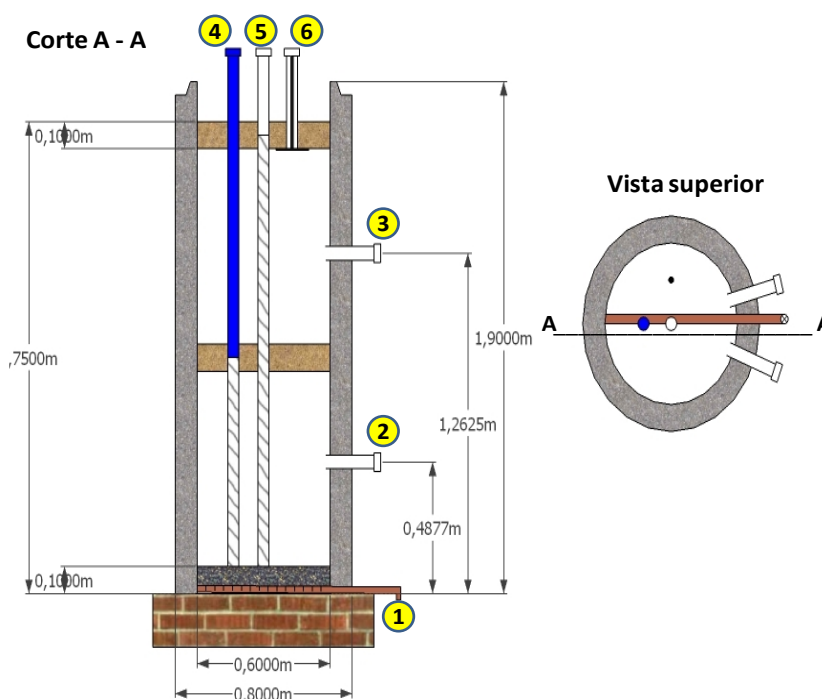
Corte do Lisímetro e equipamentos de instrumentação. (1. Tubo de drenagem, 2 e 3 Tubo de coleta de sólidos, 4. Dreno de gás, 5. Piezômetro, e 6. Placa de recalque).
